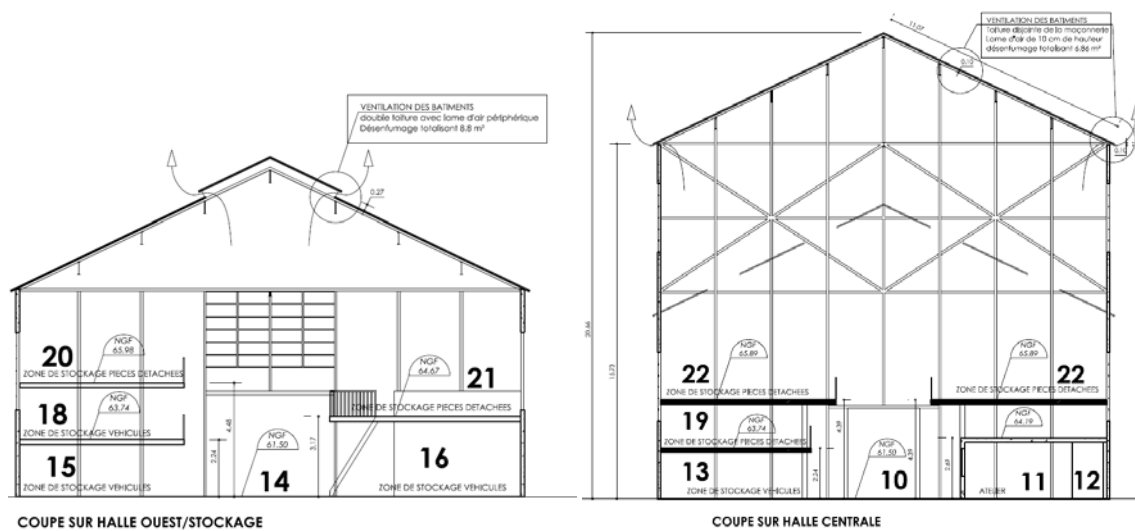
Bâtiment 1 – détail du désenfumage existant
